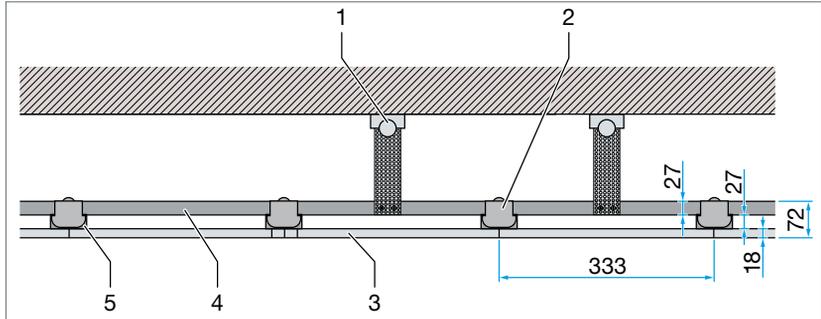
Schnittzeichnung der Deckenkonstruktion
